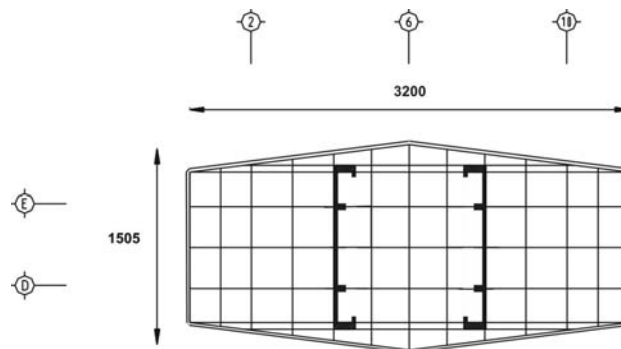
planta tipo del edificio apéndice niveles 17 y 18
